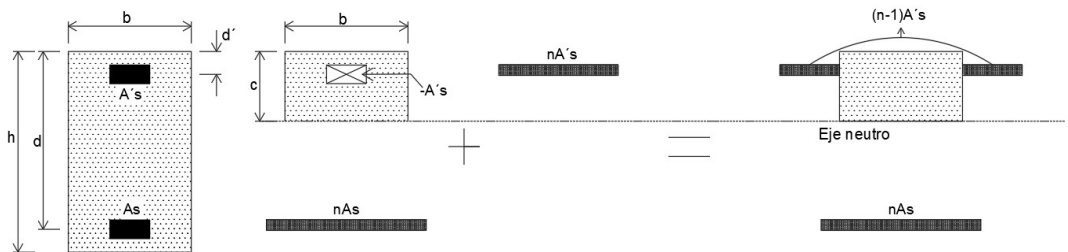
Sección transformada agrietada. Adaptado de “Apuntes del curso de Concreto Armado 1”
